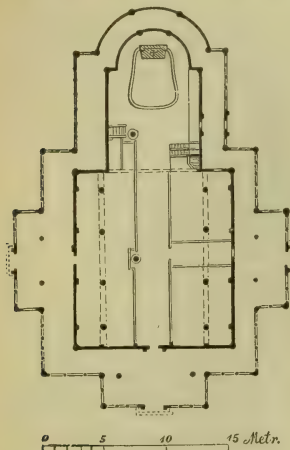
Kirche zu Hitterdal. Grundriß.
